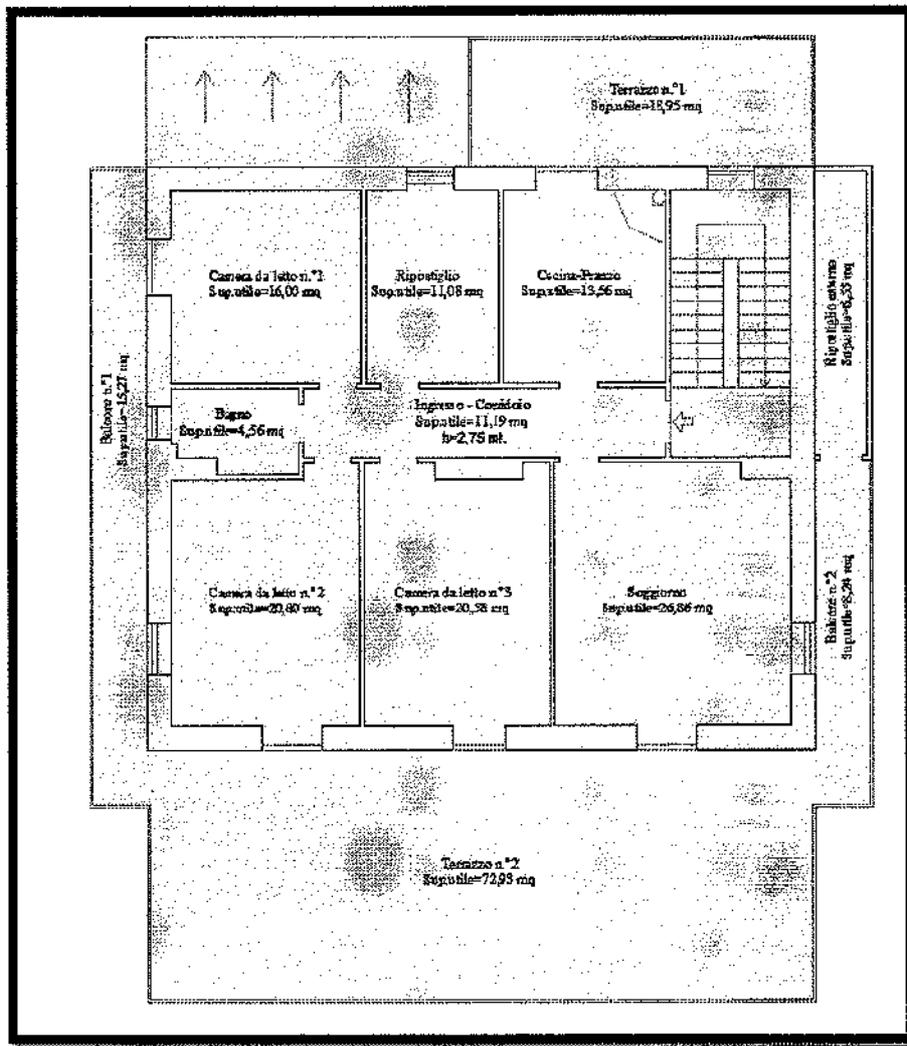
Rilievo appartamento part. 124 sub 5 – Piano primo
